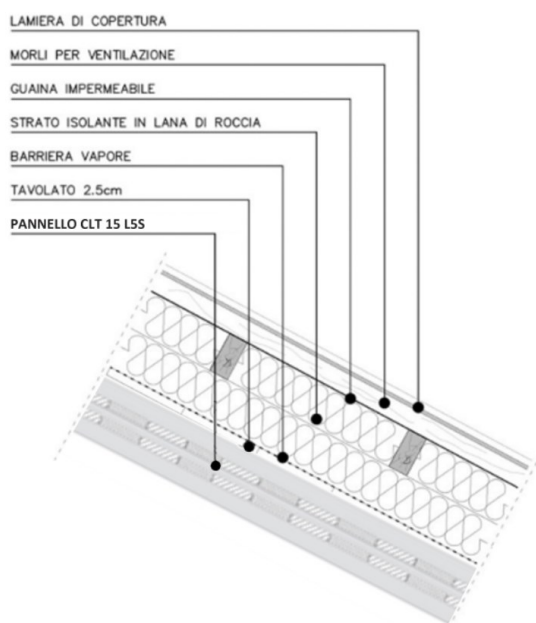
Sezione tipica della copertura (Pegoraro, 2021).
